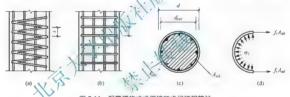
配置螺旋式或焊接环式间接钢筋柱
